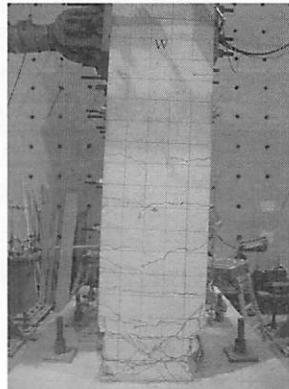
No. 2 供試体の損傷状況 (10δ 載荷終了時)
